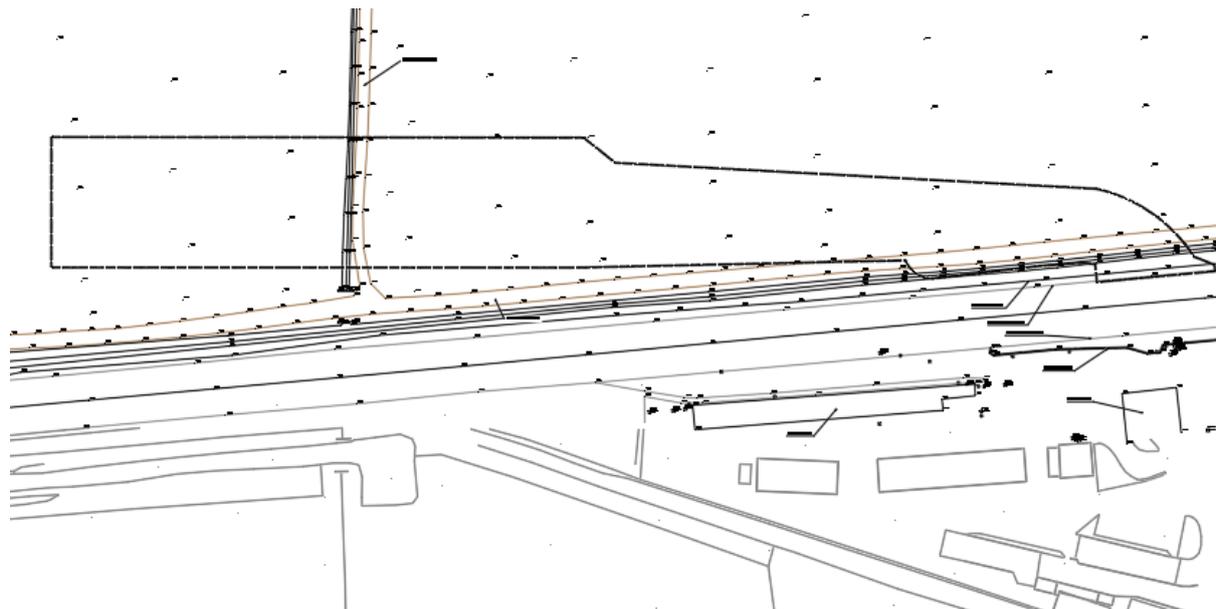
Estratto planimetrico dello stato di fatto – Individuazione dell'area oggetto di intervento con polilinea nera tratteggiata.
